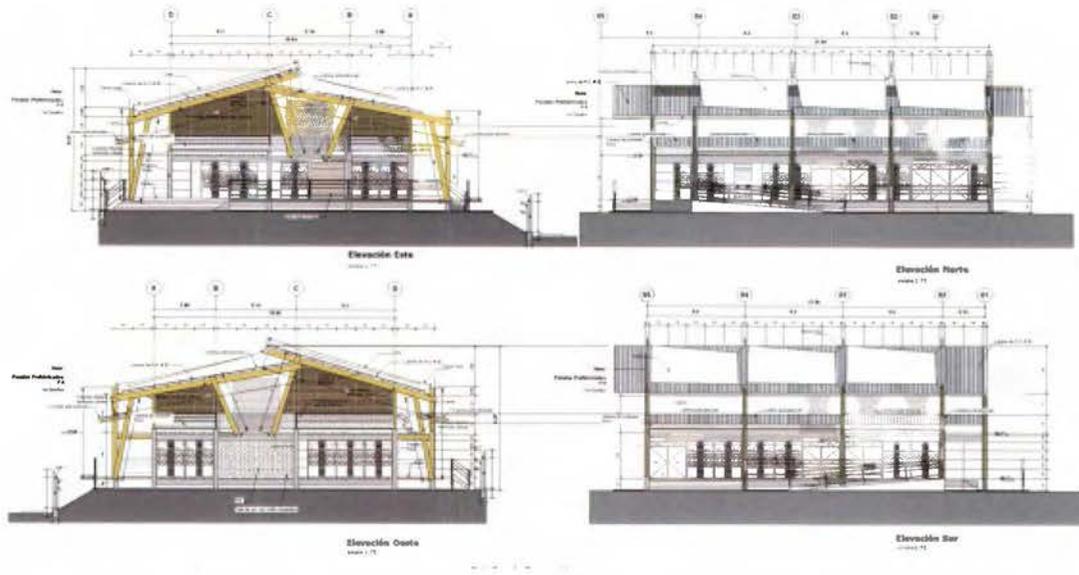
Planimetría del CECUDI: Elevación Norte, Sur, Este y Oeste. Fuente: EntreNos Atelier, Michael Smith.
